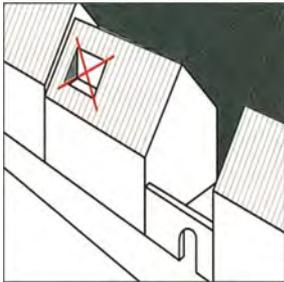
Keine Dacheinschnitte auf der Straßenseite
